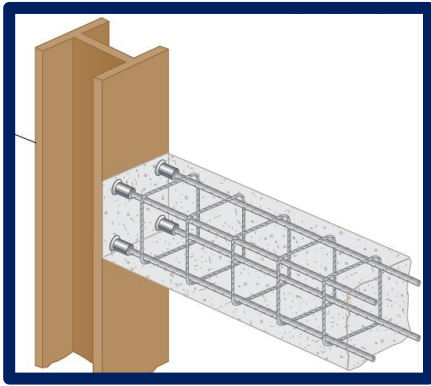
Conector diseñado para soldaduras de elementos estructurales metálicos.
